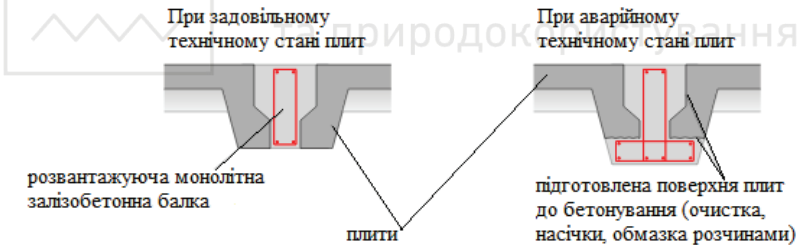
Підсилення плит влаштуванням розвантажувальних монолітних залізобетонних балок з розсуванням плит
